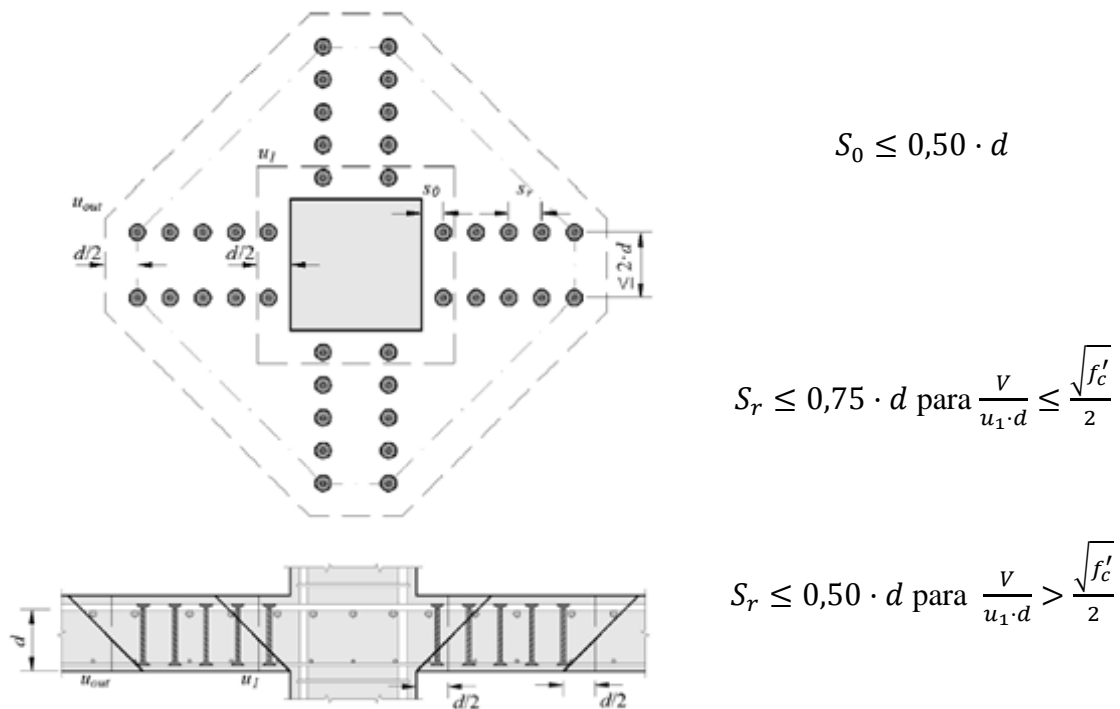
Detalhes para distribuição da armadura de cisalhamento (ACI 318:08)
